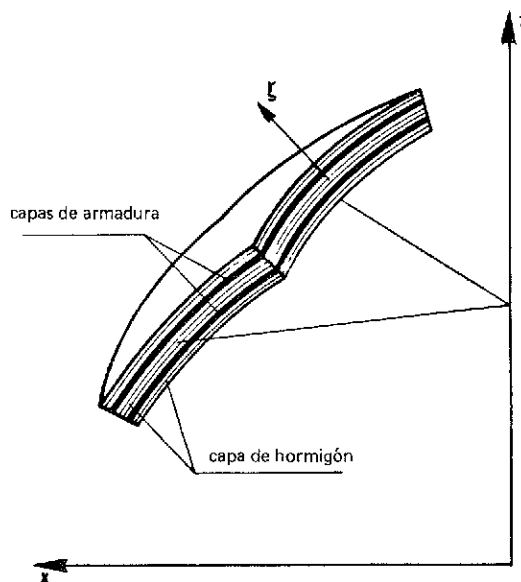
Elemento de lámina, descompuesto en capas de hormigón y acero.
